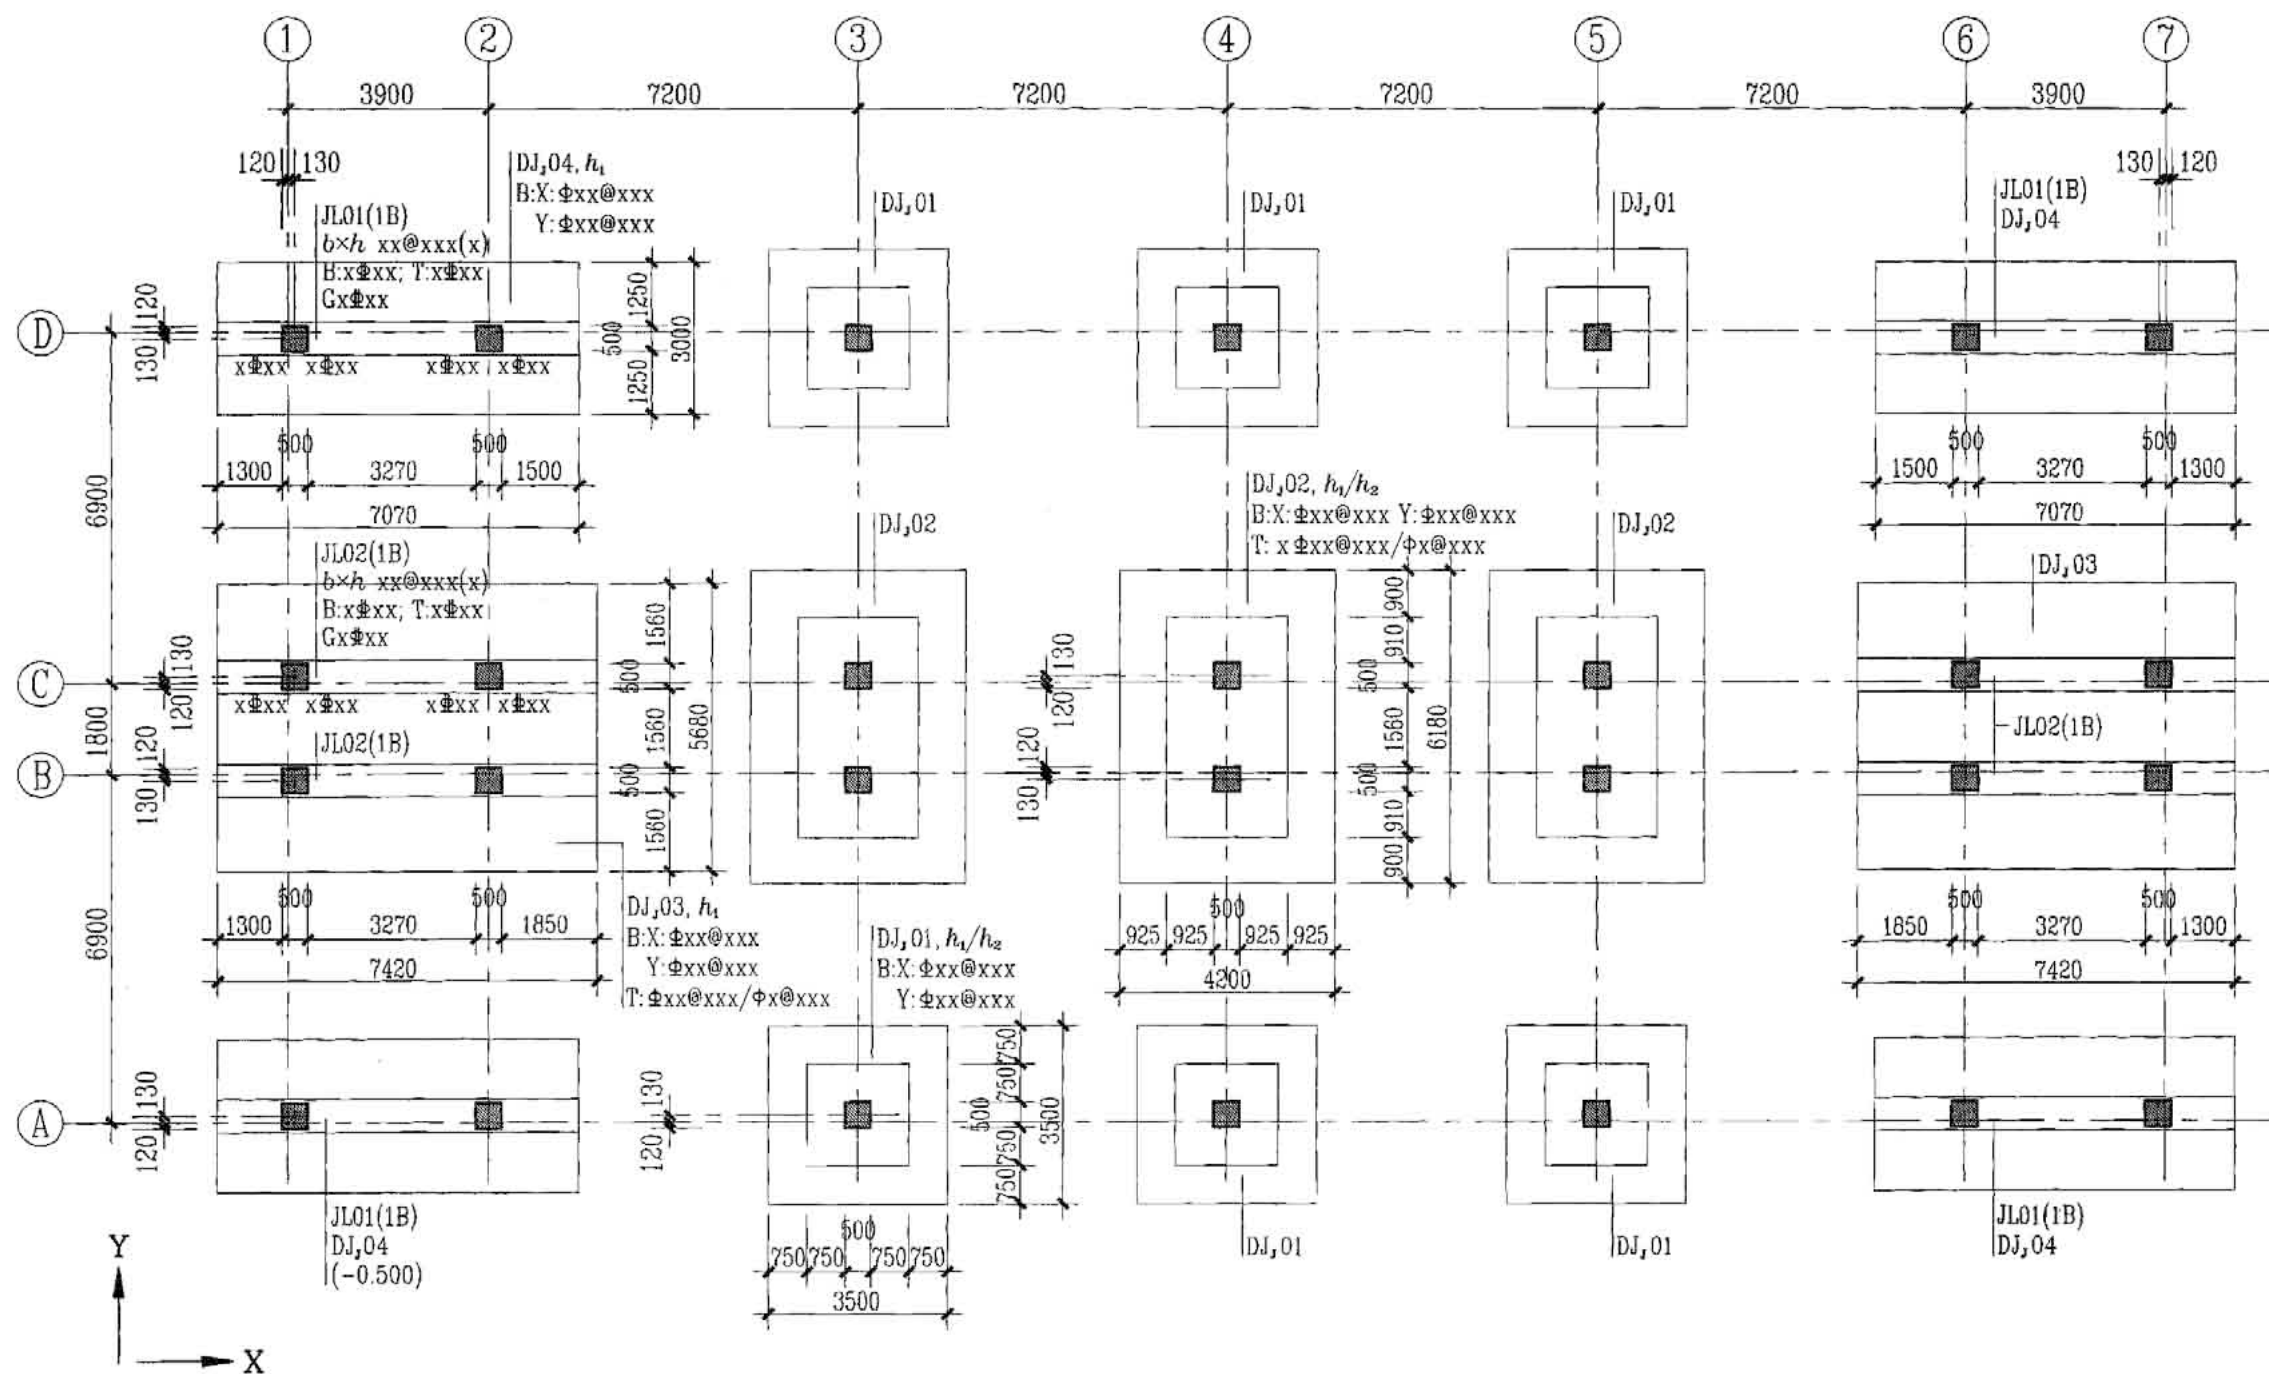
采用平面注写方式表达的独立基础设计施工图示意
